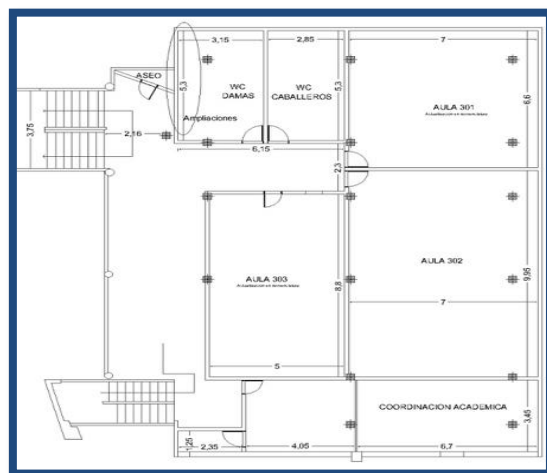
Distribución arquitectónica 3° piso edificio #2. Fuente: Propietario
